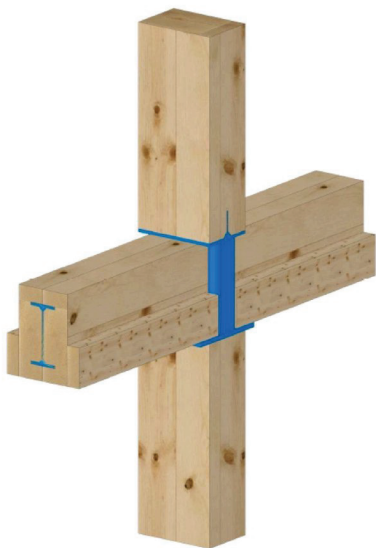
Lastendurchleitungsdetail mit Stahlprofil,
